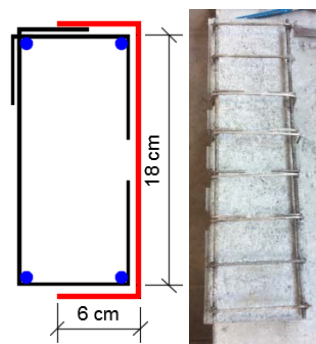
Recuperação do modelo 7. Corte das faces laterais do pilar para ancoragem do estribo com o grauteamento e com arame recozido. Fonte: Autor, 2017.
